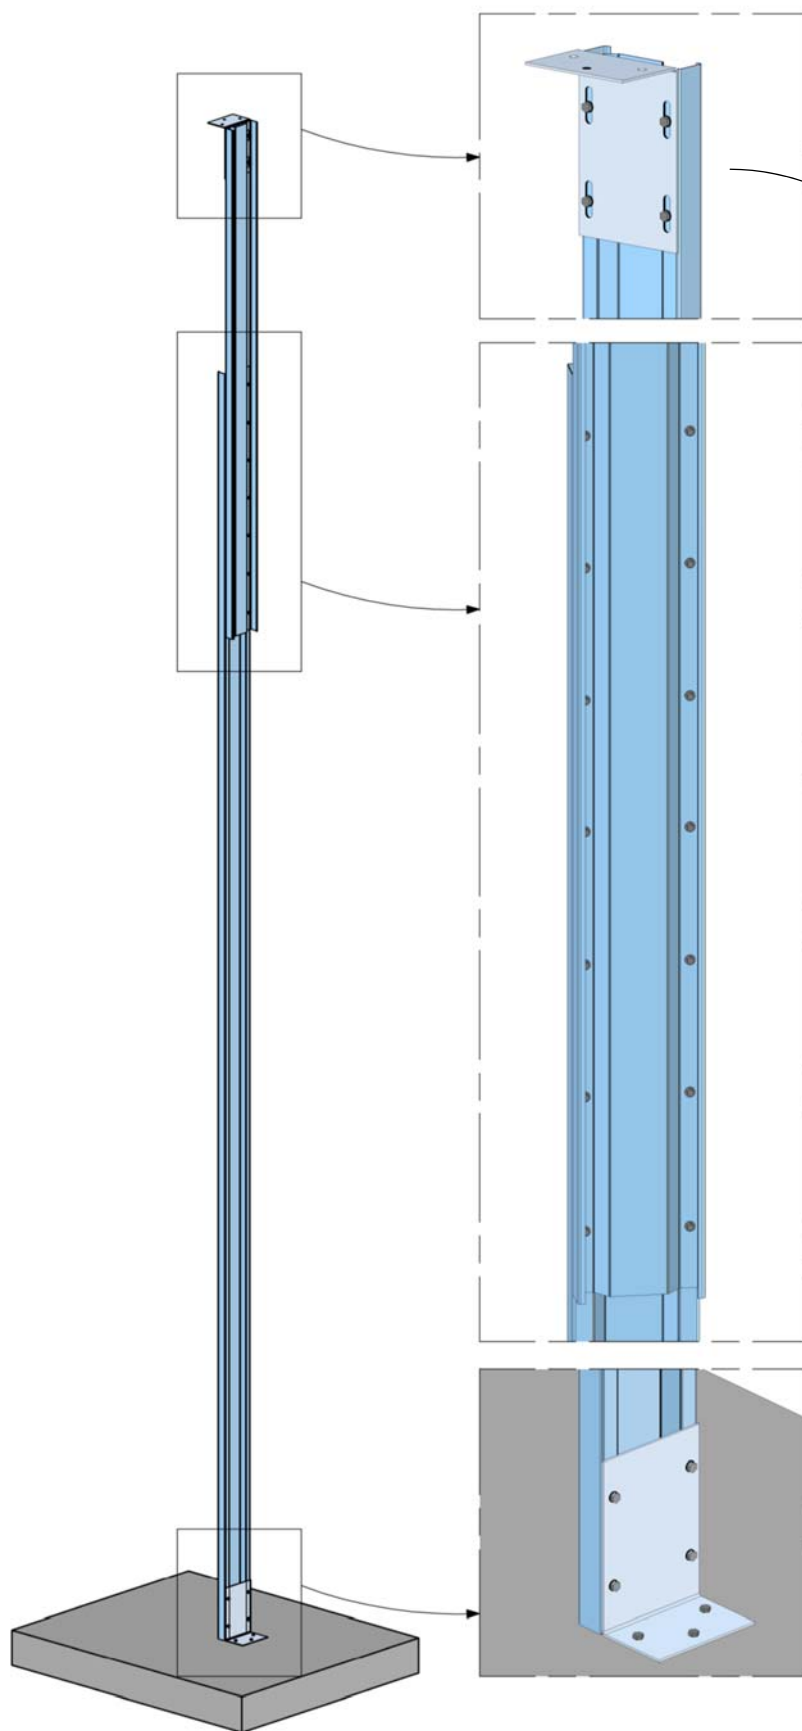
Prolongement par recouvrement d'un profilé primaire GH Futur – Vue 3D
